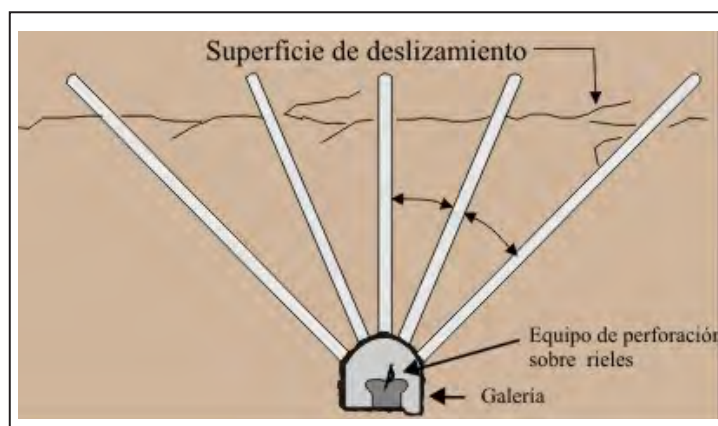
Drenaje de superficie de deslizamiento desde una galería de drenaje.
